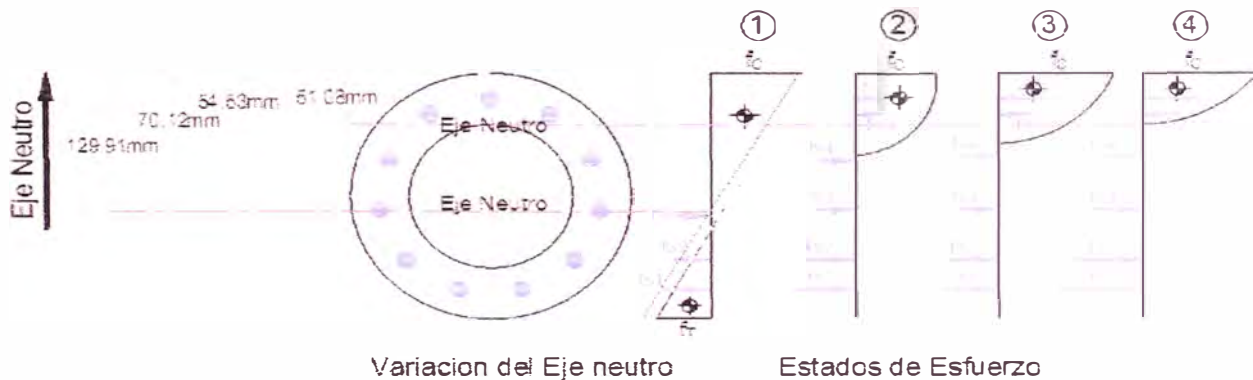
Comportamiento de la sección de concreto armado al incremento de carga
